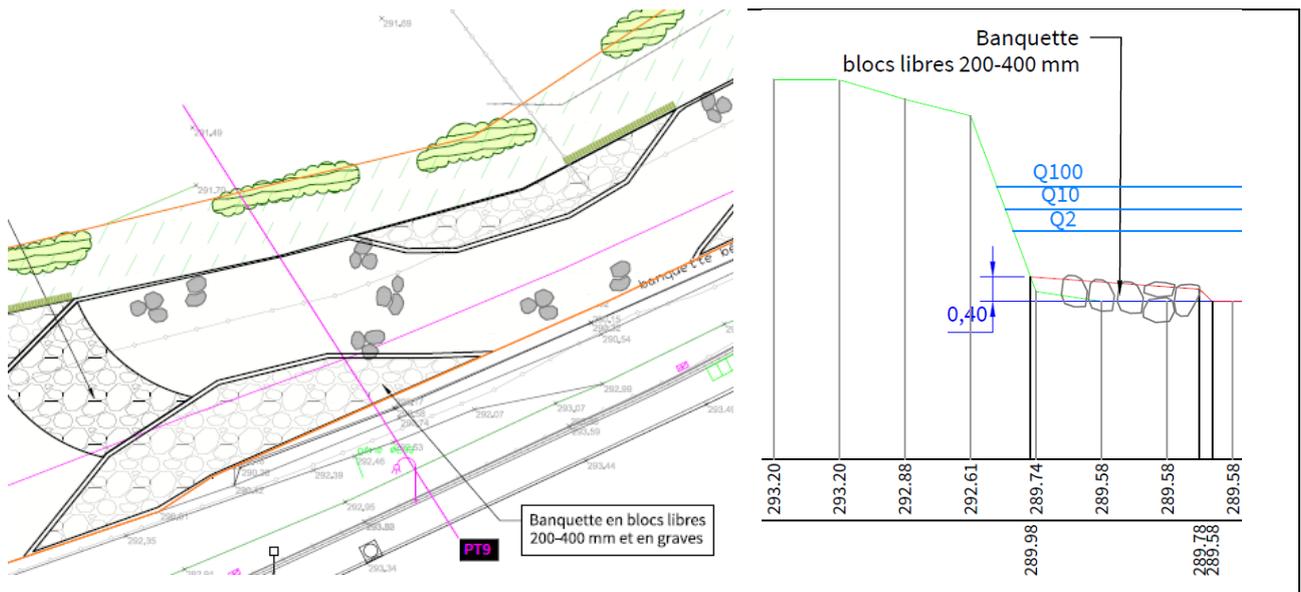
vue en plan et coupe de la banquette minérale - (échelle non précisée - cf. annexe2: cahier de plans)
